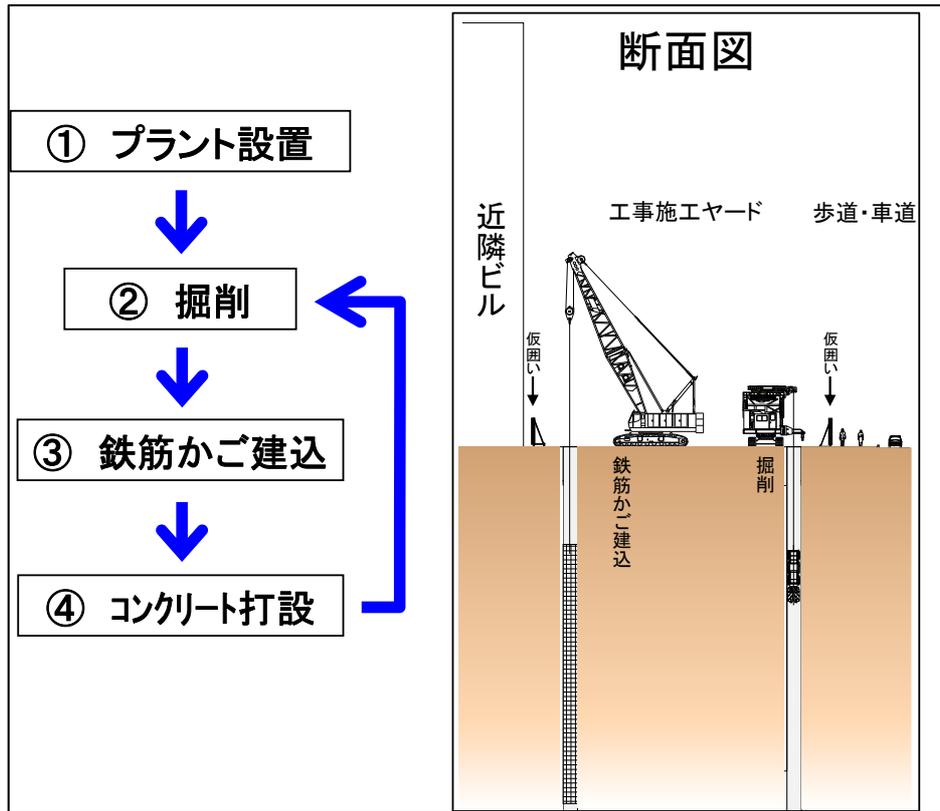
(2) 地中連続壁工の施工位置及び手順（断面図）
